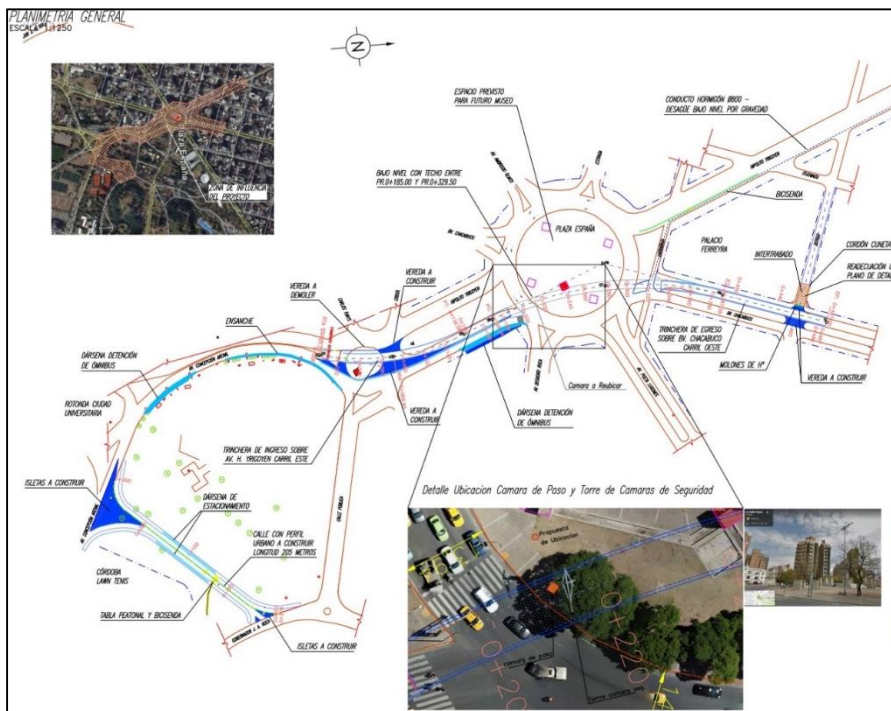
Planimetría general con cámara existente de video vigilancia de la policía. (PLANO N° 23)
